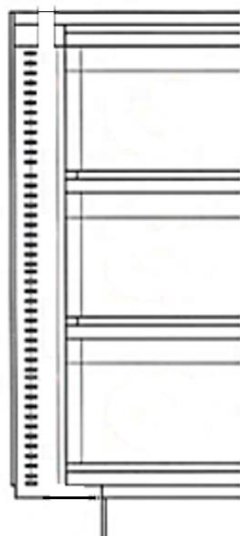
Fachada tipo tampão (adaptada de Boake 2014).
